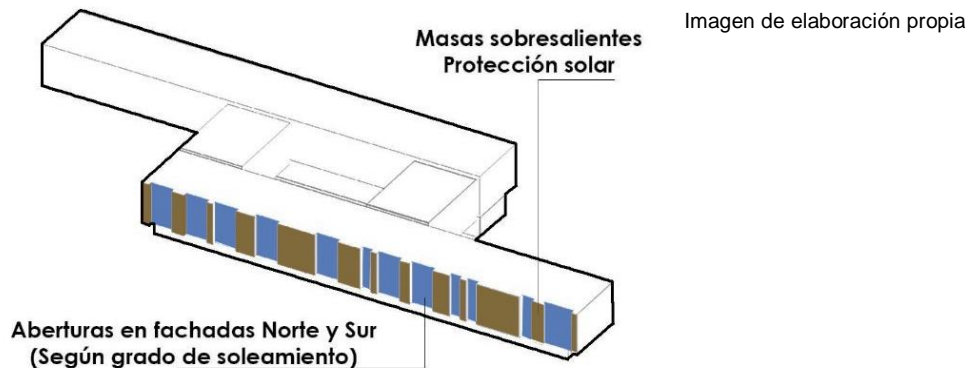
Manejo de la permeabilidad en Fachadas norte y sur
